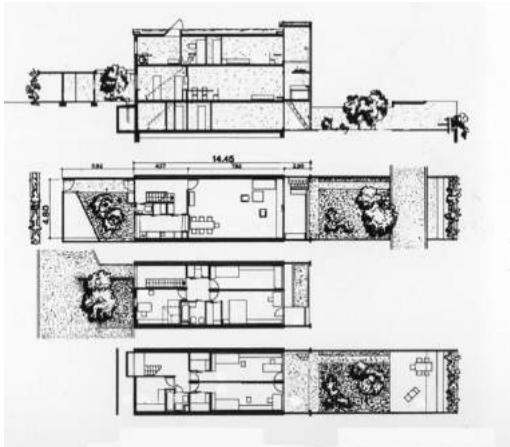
Plan et coupe type A, Atelier 5, Siedlung Halen
